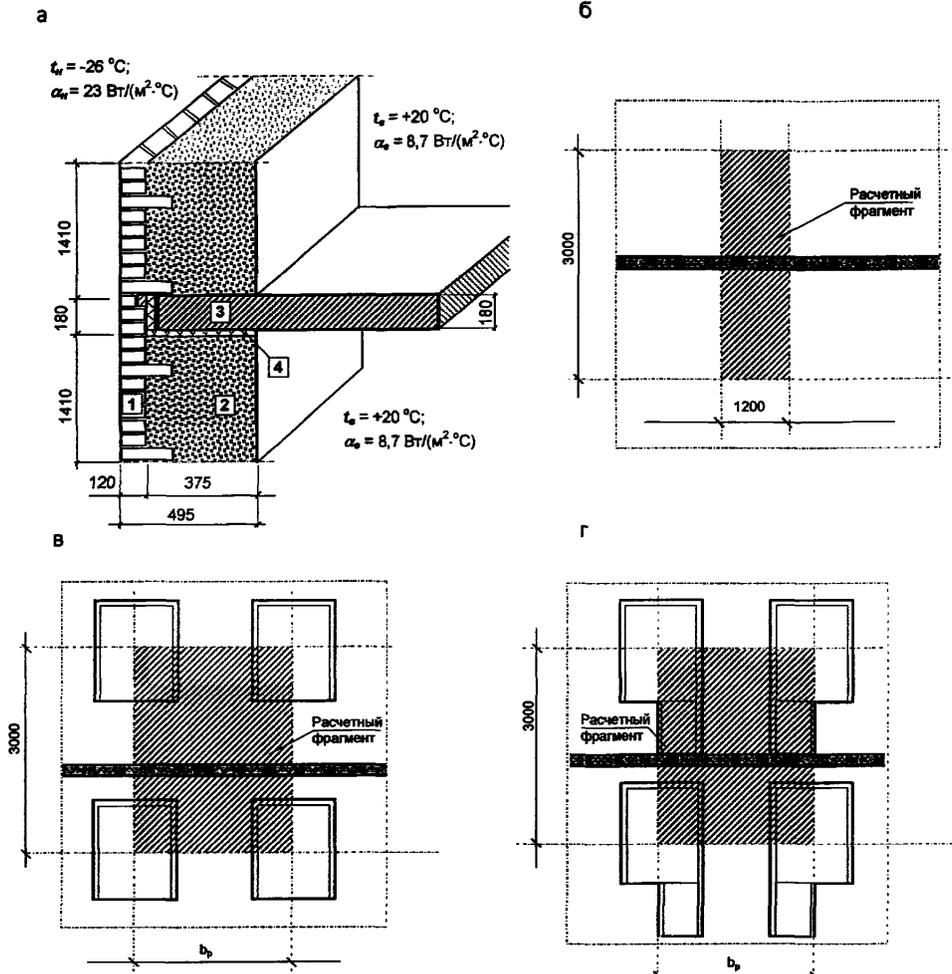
Конструктивное решение (а) и схемы расчетных фрагментов (б, в, г) наружной стены к примеру Н.3:
